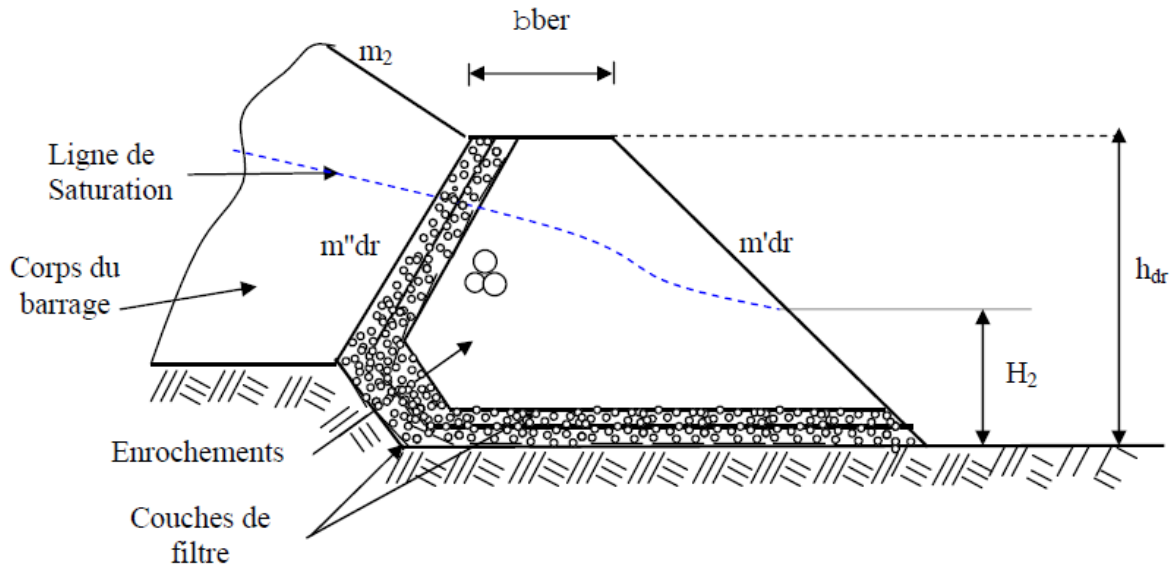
Prisme de drainage (Messaid, 2009).
